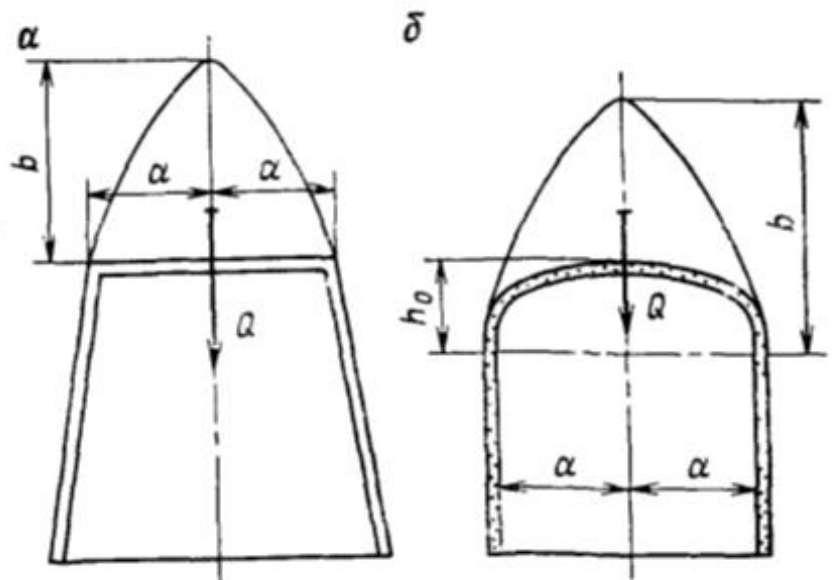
Расчет нагрузки со стороны кровли.
